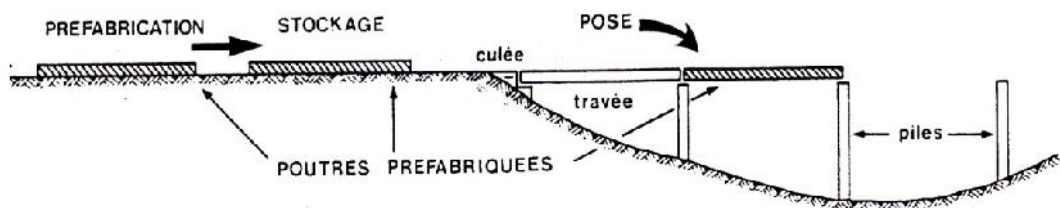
Lancement et la mise en place des poutres préfabriquées
